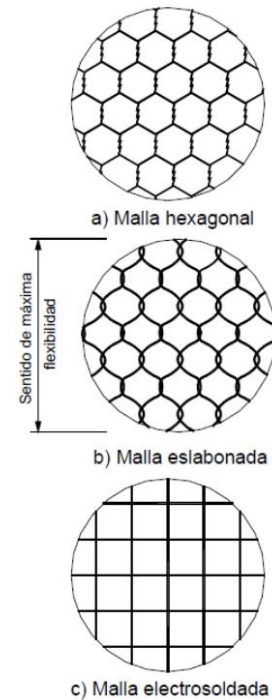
Tipos de mallas utilizadas en la construcción de gaviones. Fuente: (Suárez Díaz, 2001).
